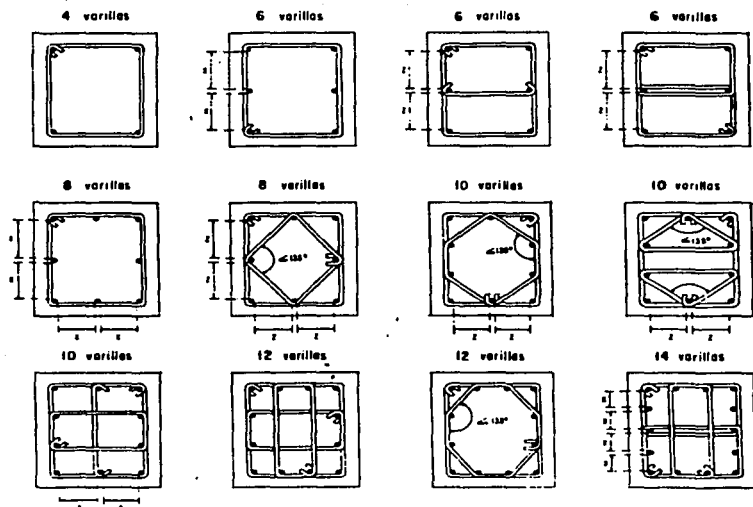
Arreglos típicos de estribos en columnas de concreto
